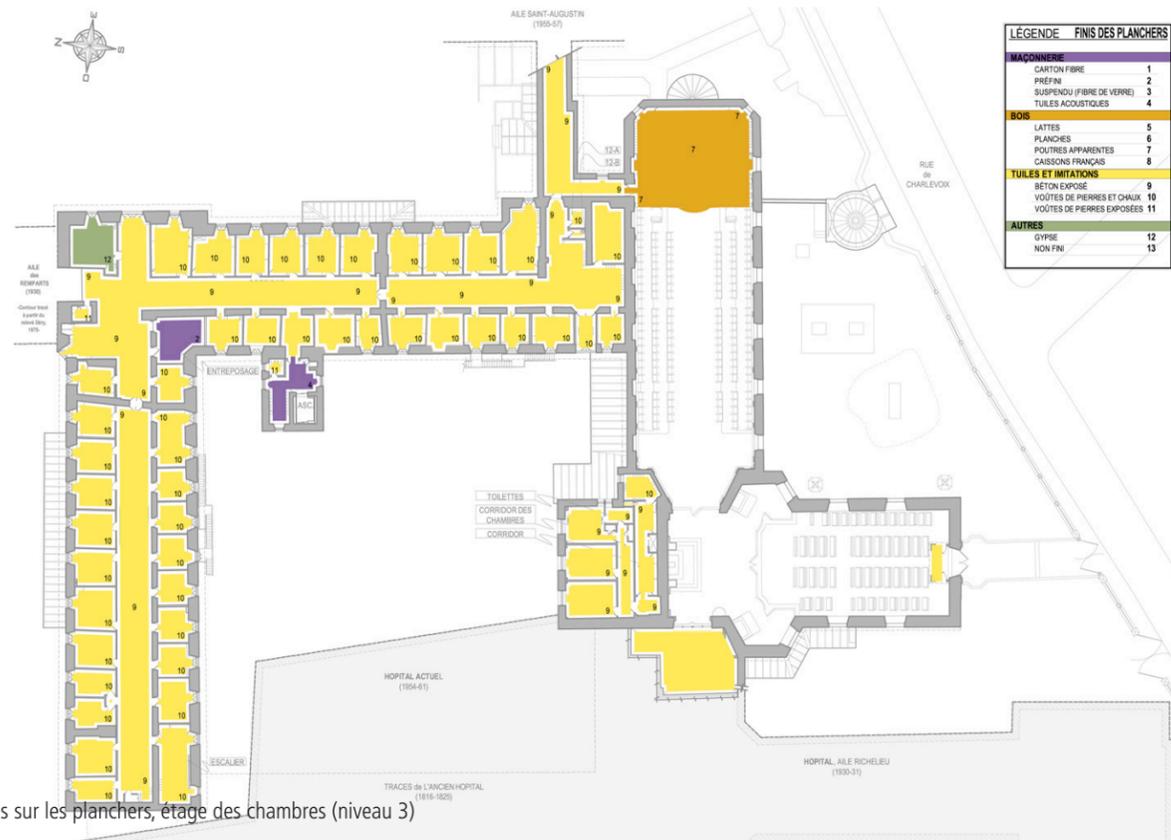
Plan des fins sur les planchers, étage des chambres (niveau 3)
